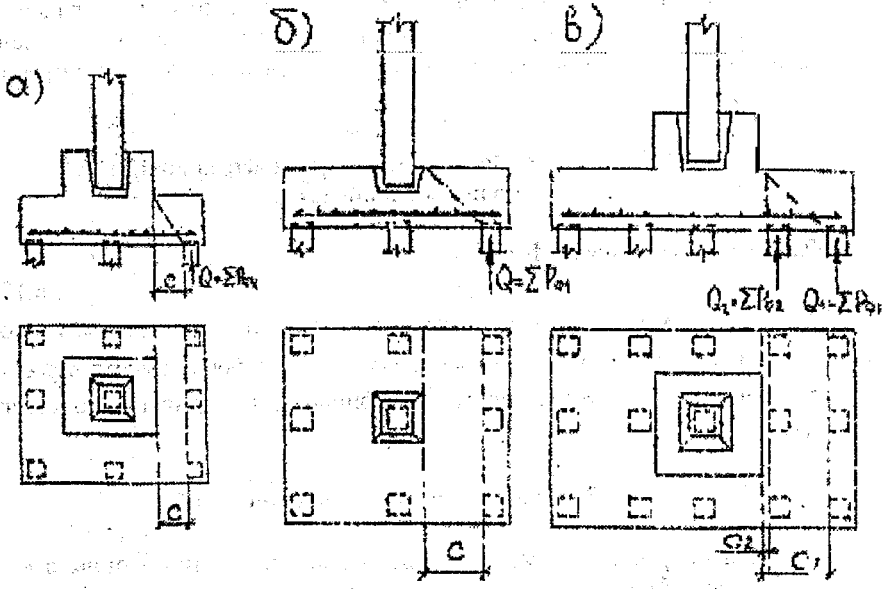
Схемы, принимаемые при расчете прочности наклонных сечений ростверка по поперечной силе для ростверка с подколонником (а), плитного ростверка (б) и ростверка с многорядным расположением свай за гранью подколонника (в)
